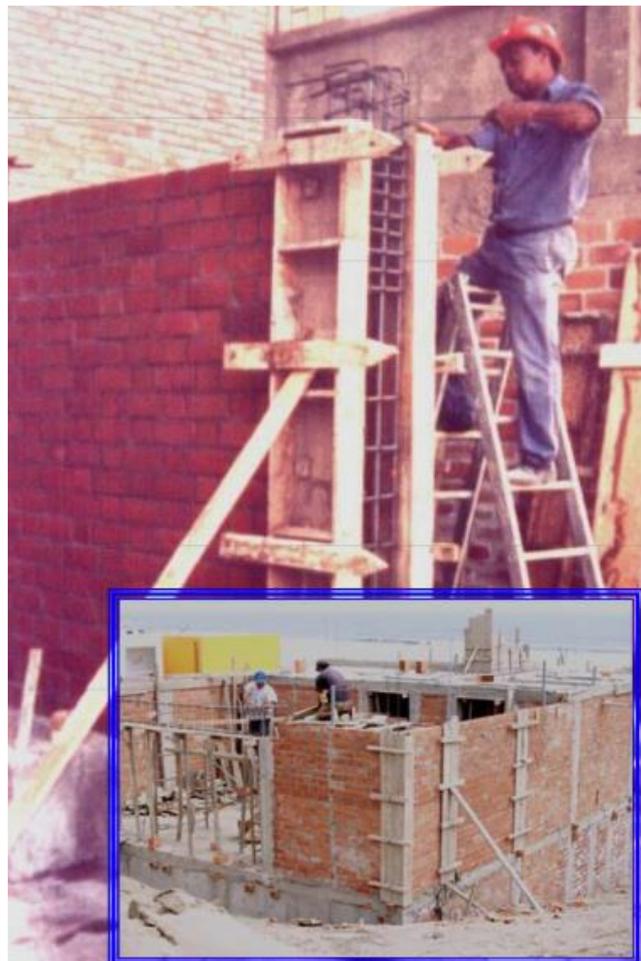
Detalle de Columna en confinamiento de concreto armado - Fuente: San
